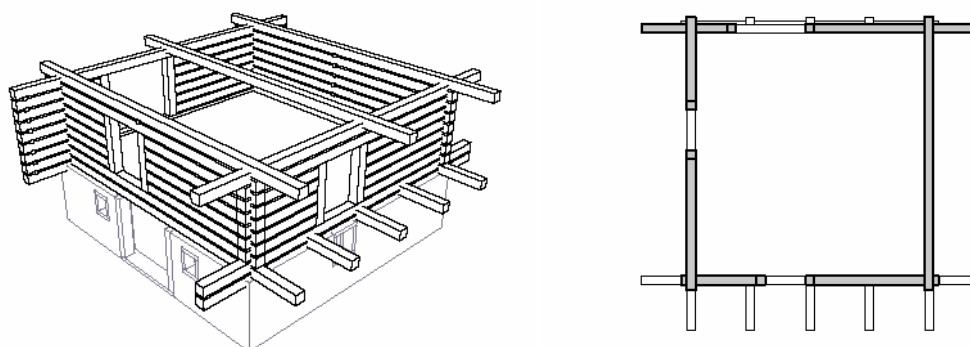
Rappresentazione tridimensionale e pianta del fienile
